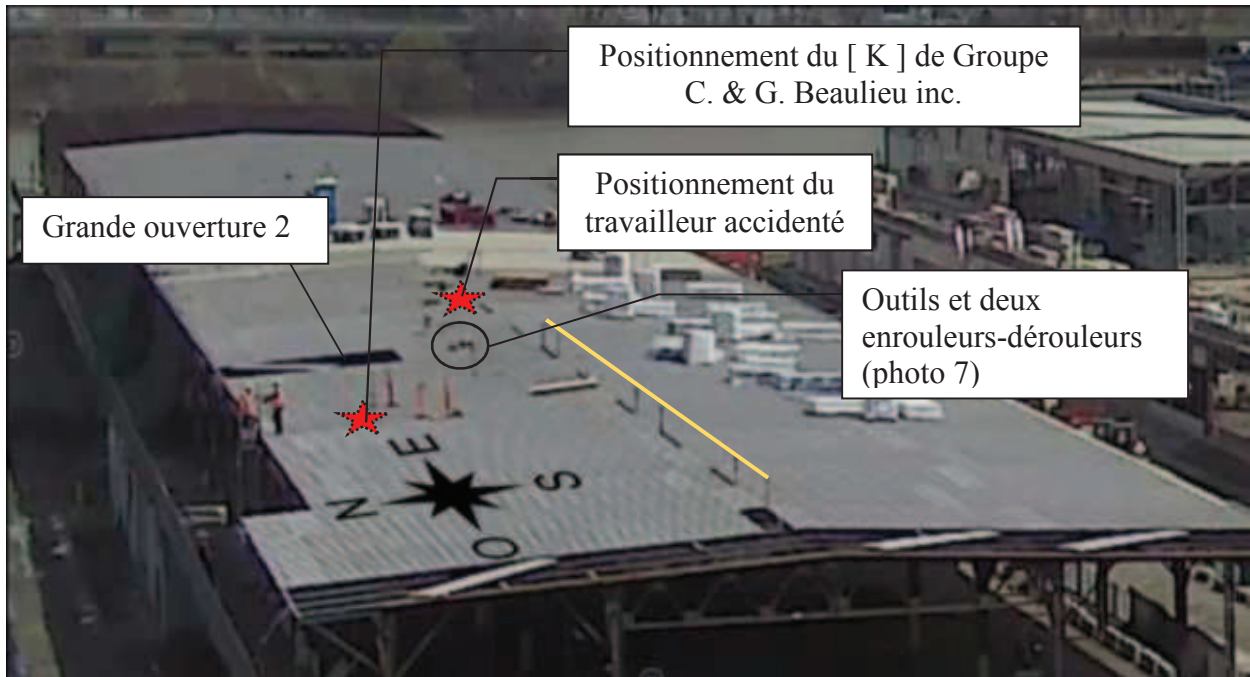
État des lieux avant le début des travaux le 27 avril 2017
